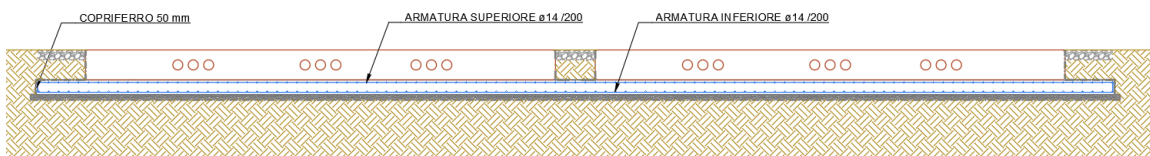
Sezione B della platea di fondazione della Cabina di Centrale
